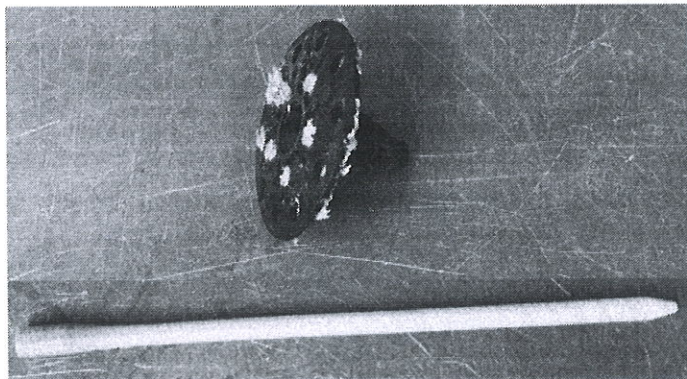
Тарельчатый держатель и распорный элемент анкера.
